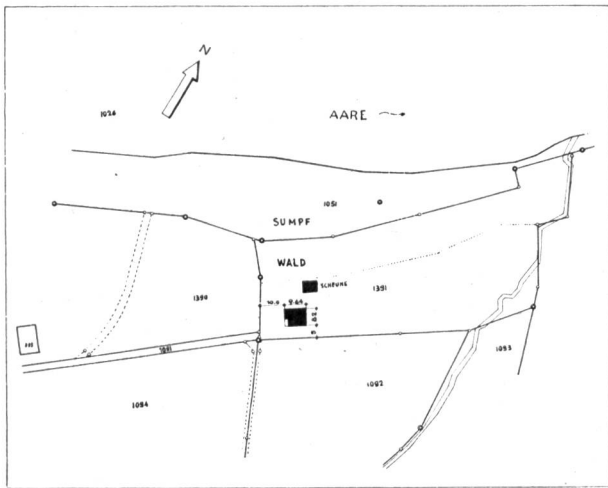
Situationsplan zu dem auf Grund des Zonenplanes abgelehnten Baugesuch. Ueber die Lage der «Bau-parzelle» vgl. Abb. 1.
